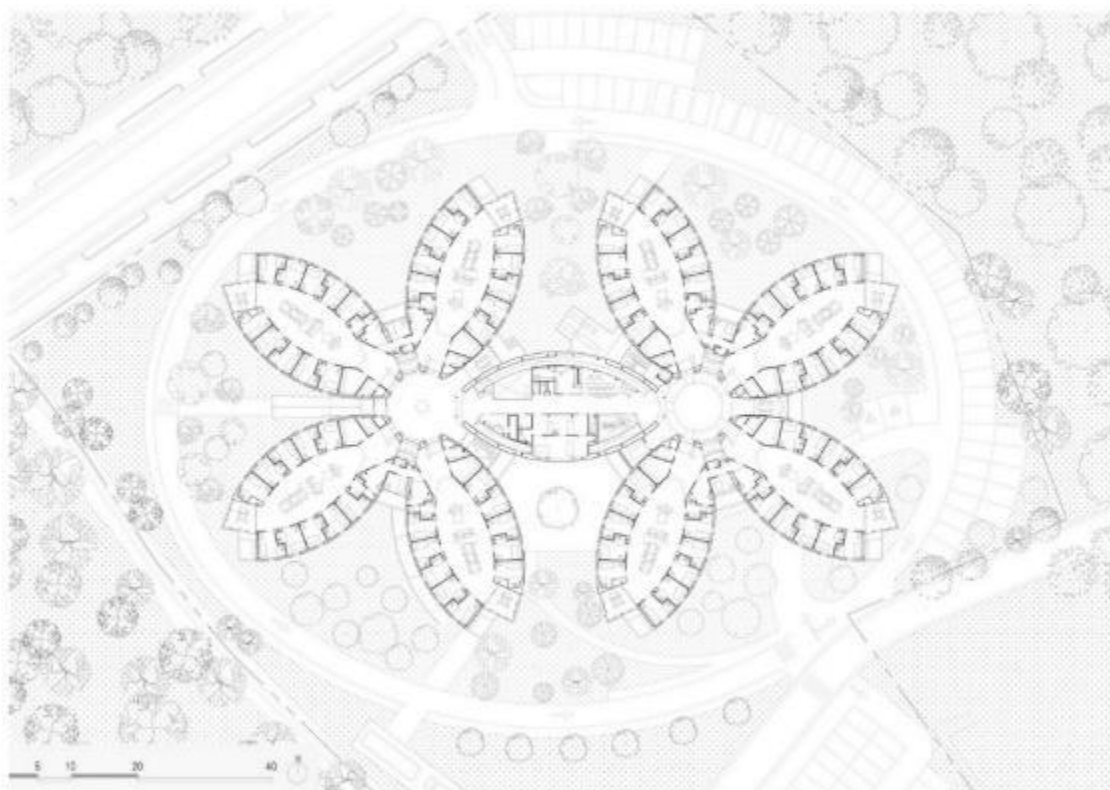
План 2 поверху будівлі «Sakuragi»
